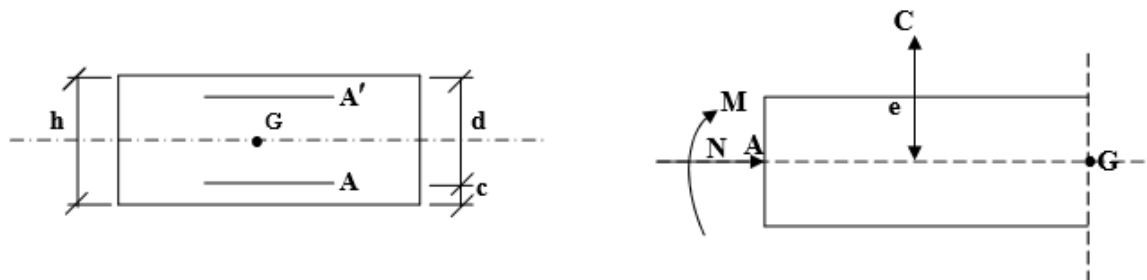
Schéma statique de la section de l'acrotère.
